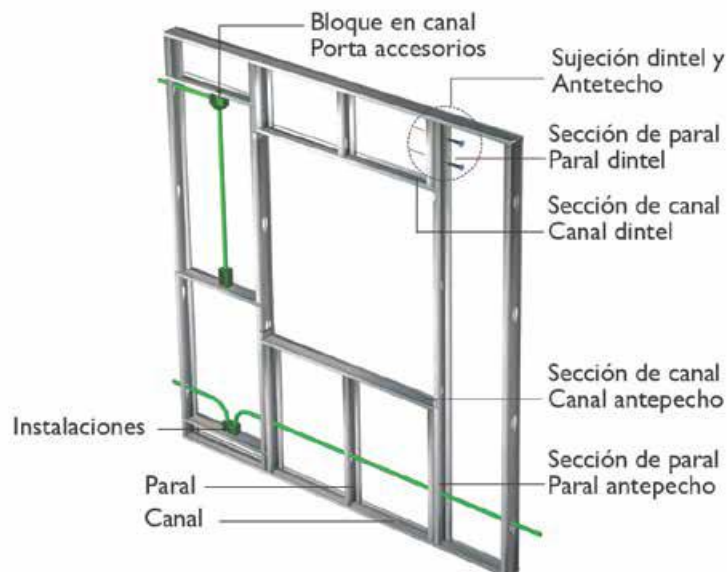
Estructura para la colocación de ventanas de aluminio y vidrio
